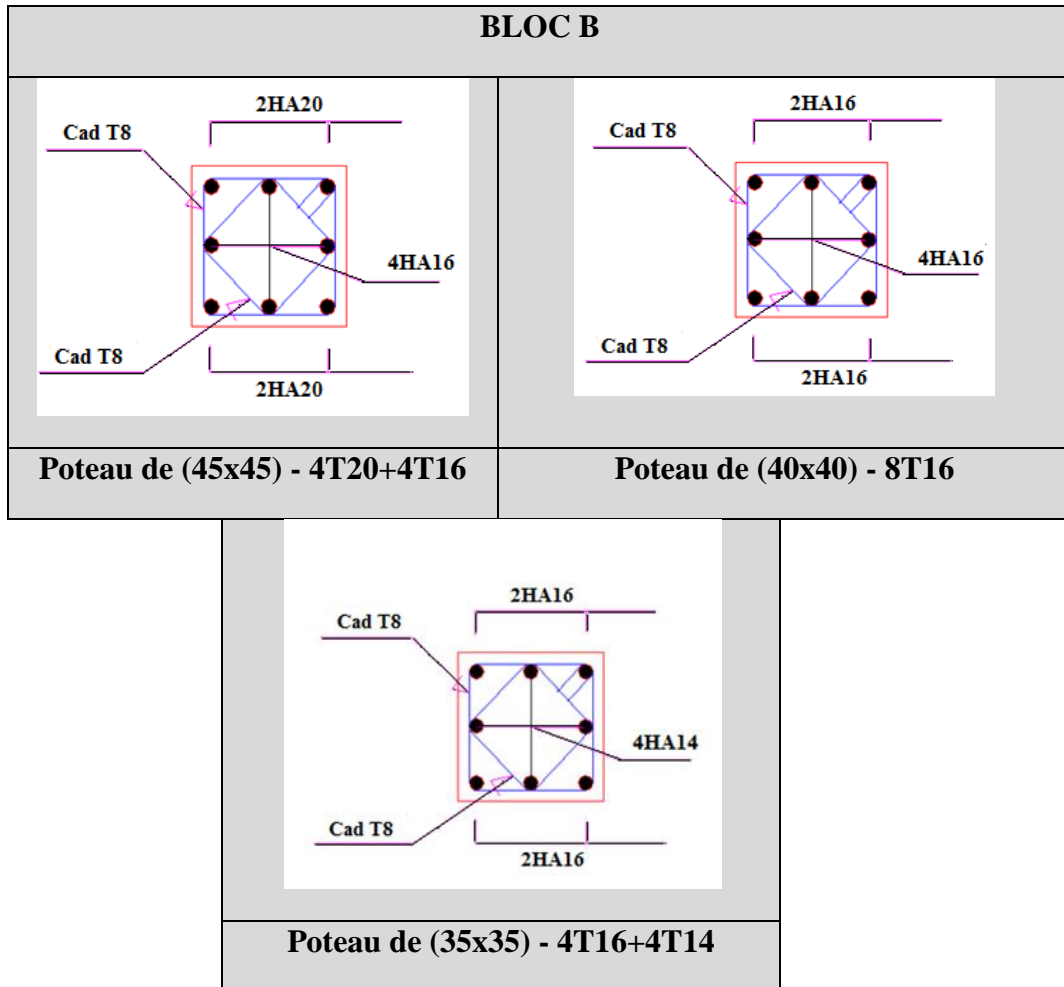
Schéma de ferrailage des poteaux bloc (B)
